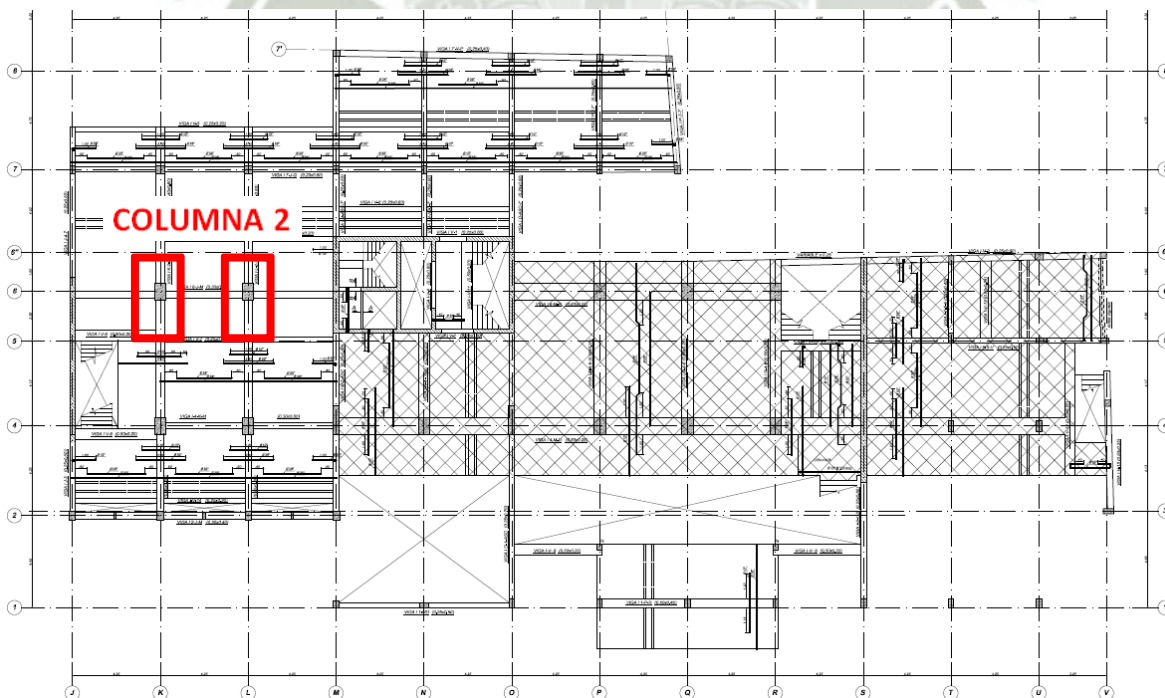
UBICACIÓN COLUMNA 2
